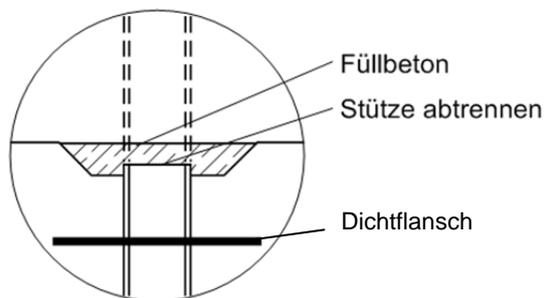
Baugrubenaussteifung in Grundwasser mit verbleibenden Stützen im Bauwerk und Dichtflansch
